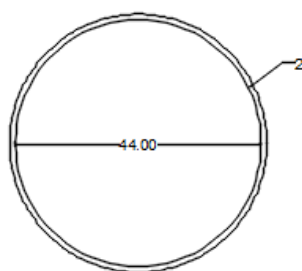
Geometria e dimensões, em mm, da secção transversal de uma escora metálica
